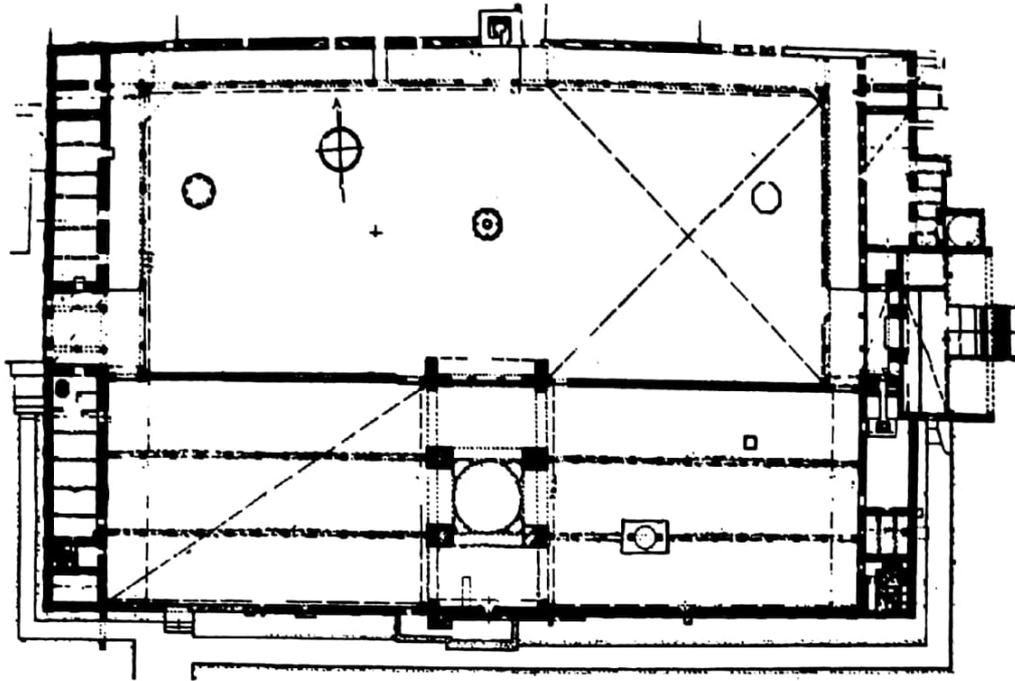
Mezquita Mayor de Damasco. Planta. (Creswell.)
